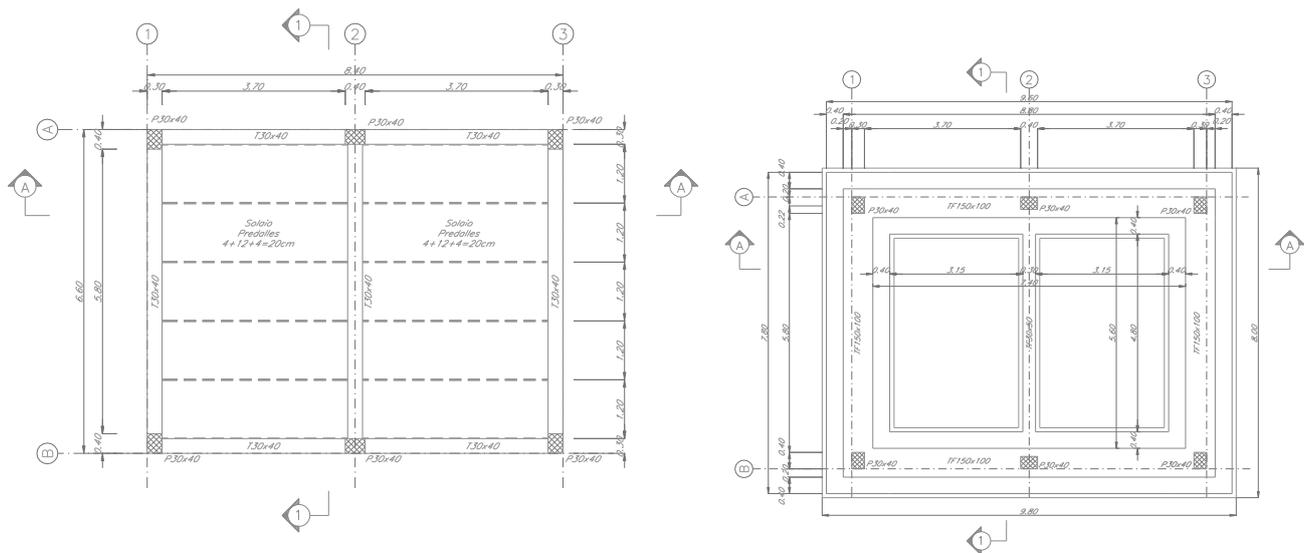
Pianta solaio e pianta fondazioni locale consegne al km 5+467,211
